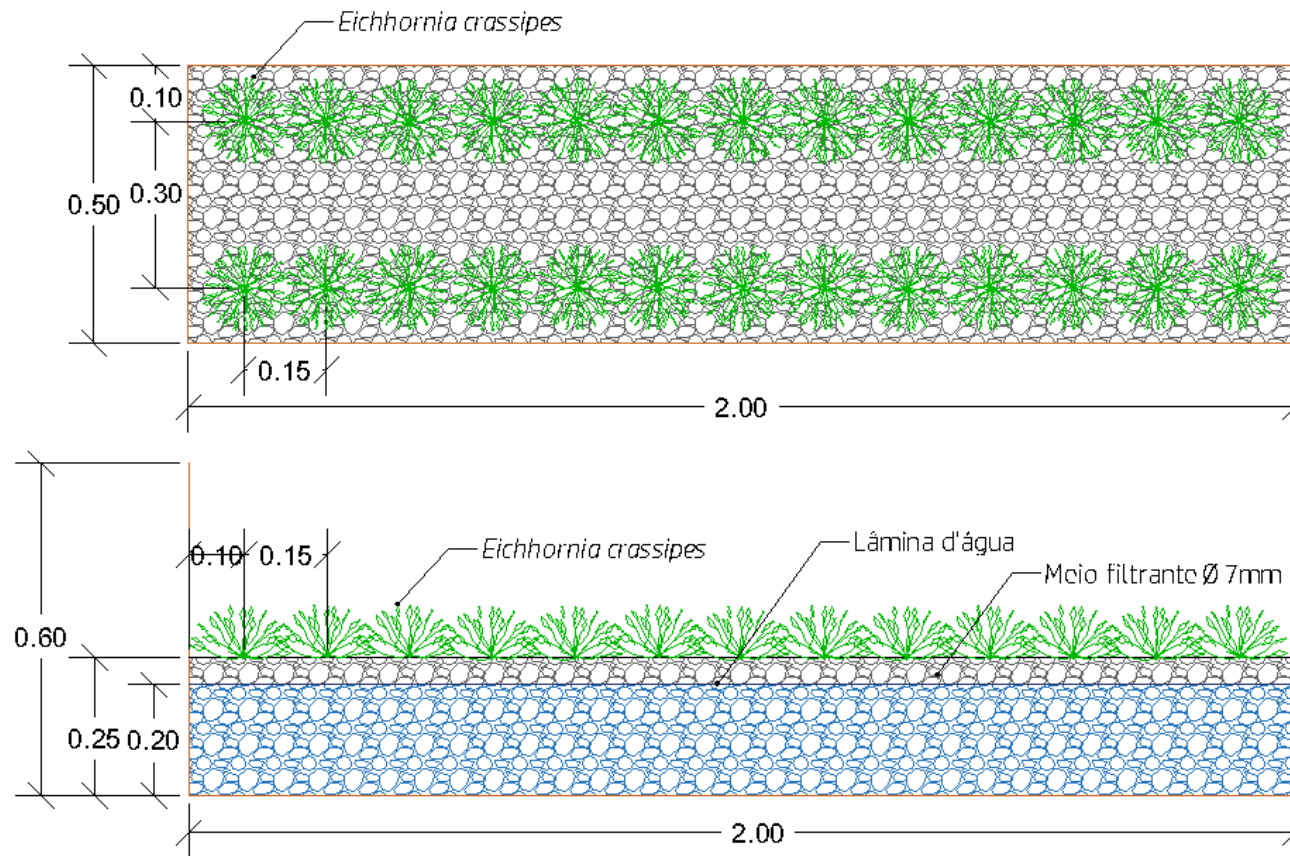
Vista superior e corte longitudinal das wetlands construídas detalhando disposição e espaçamento das plantas (*E. crassipes*), exceto para os leitos não vegetados, e as alturas da lâmina de água e meio filtrante.
